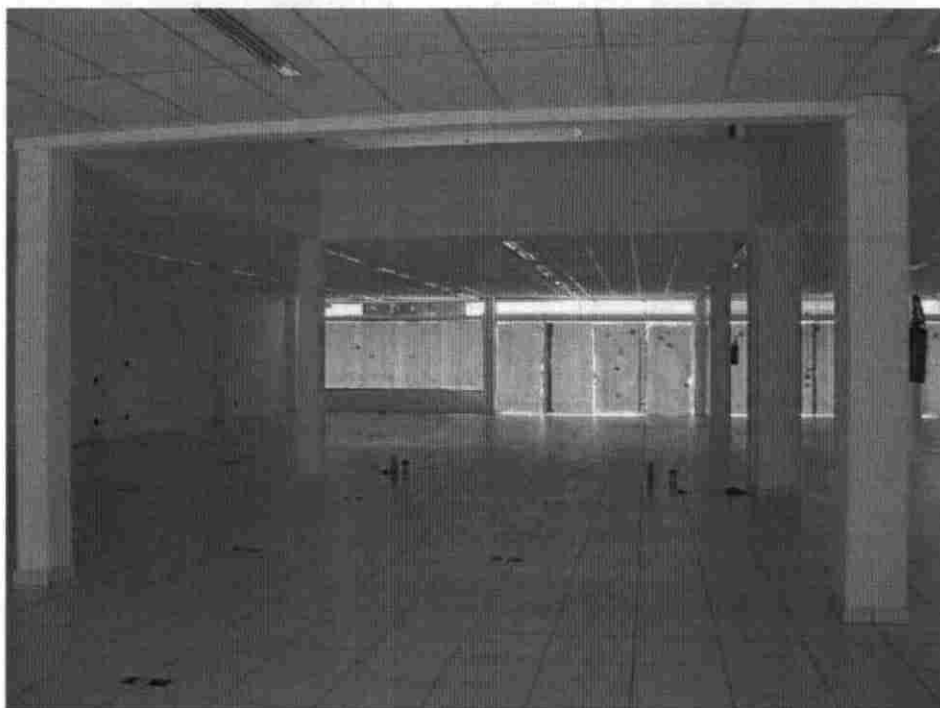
Vista geral do pavimento térreo. Destaque para o piso cerâmico.
